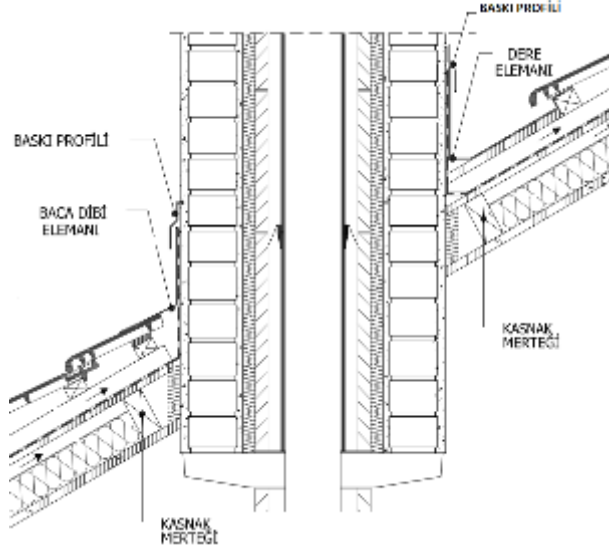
1/50 Ölçekli Çatı Planı ve Kesit Gösterimi
